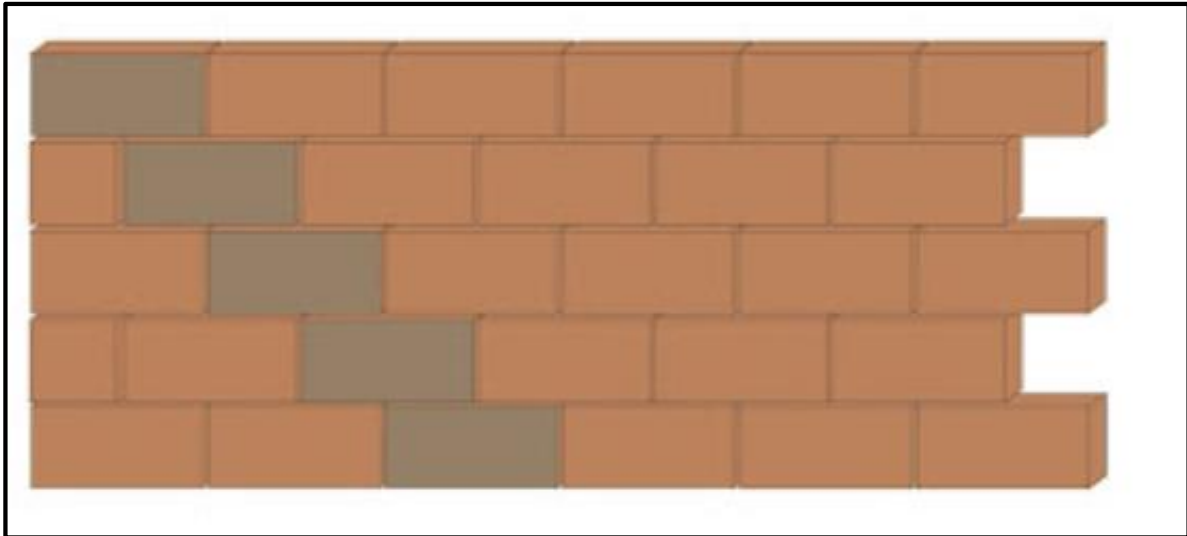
Muro de albañilería asentado con ladrillos en canto. Tomada de “Teoría básica sobre Albañilería”, por Donaire, 2011.
